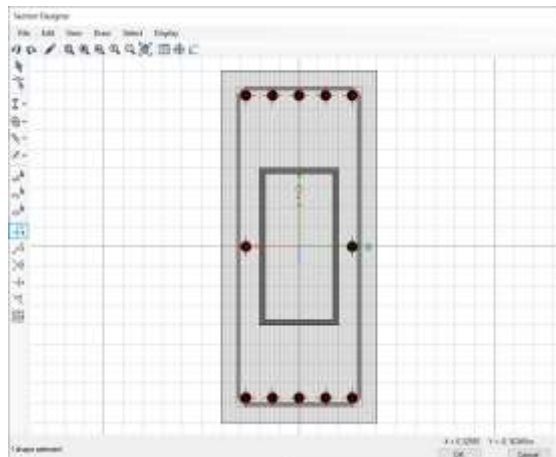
Definición de columna de 40x90 reforzada con perfil metálico tubular rectángulo
